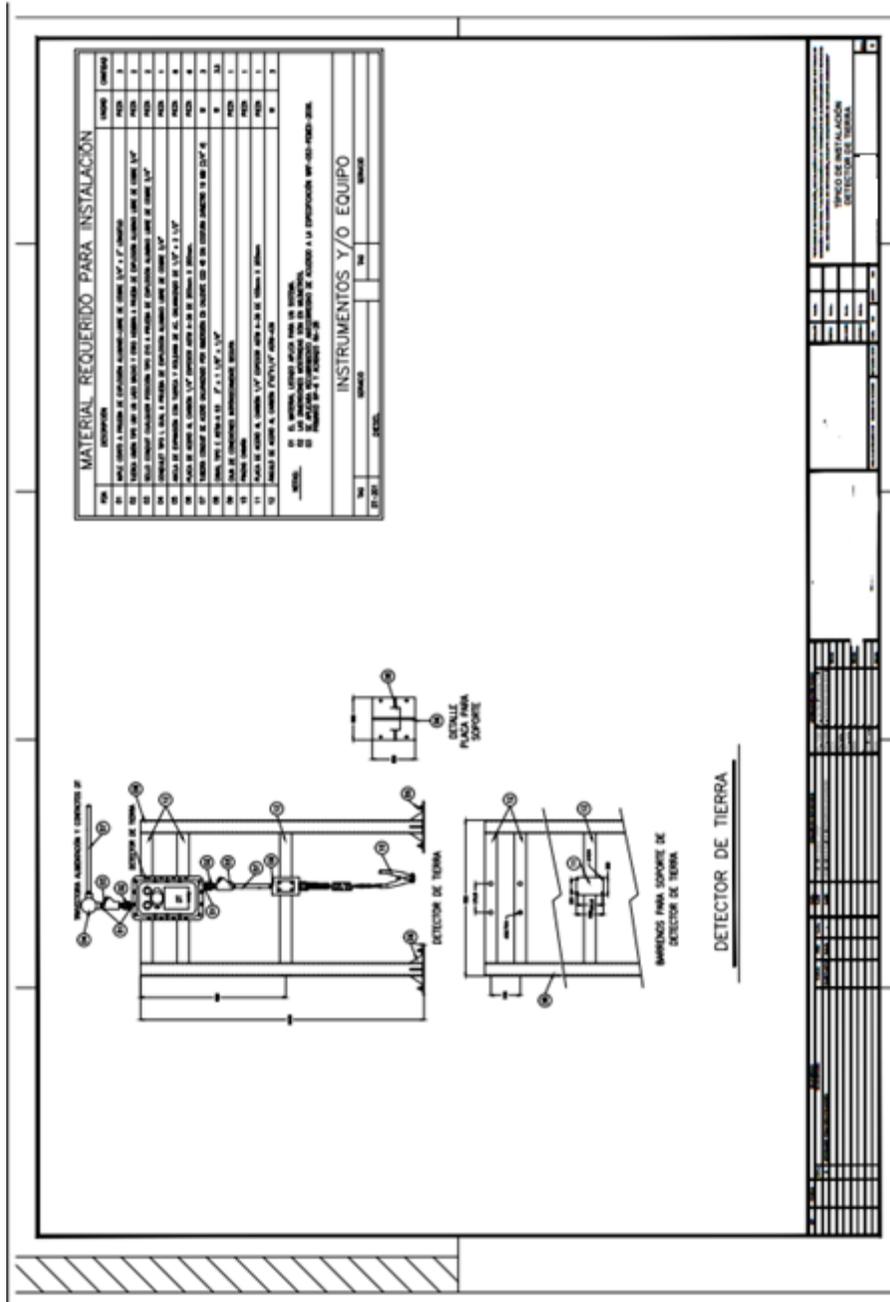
Plano Típico De Instalación De Detector De Tierras (fuente: IIESA plano P-101).
